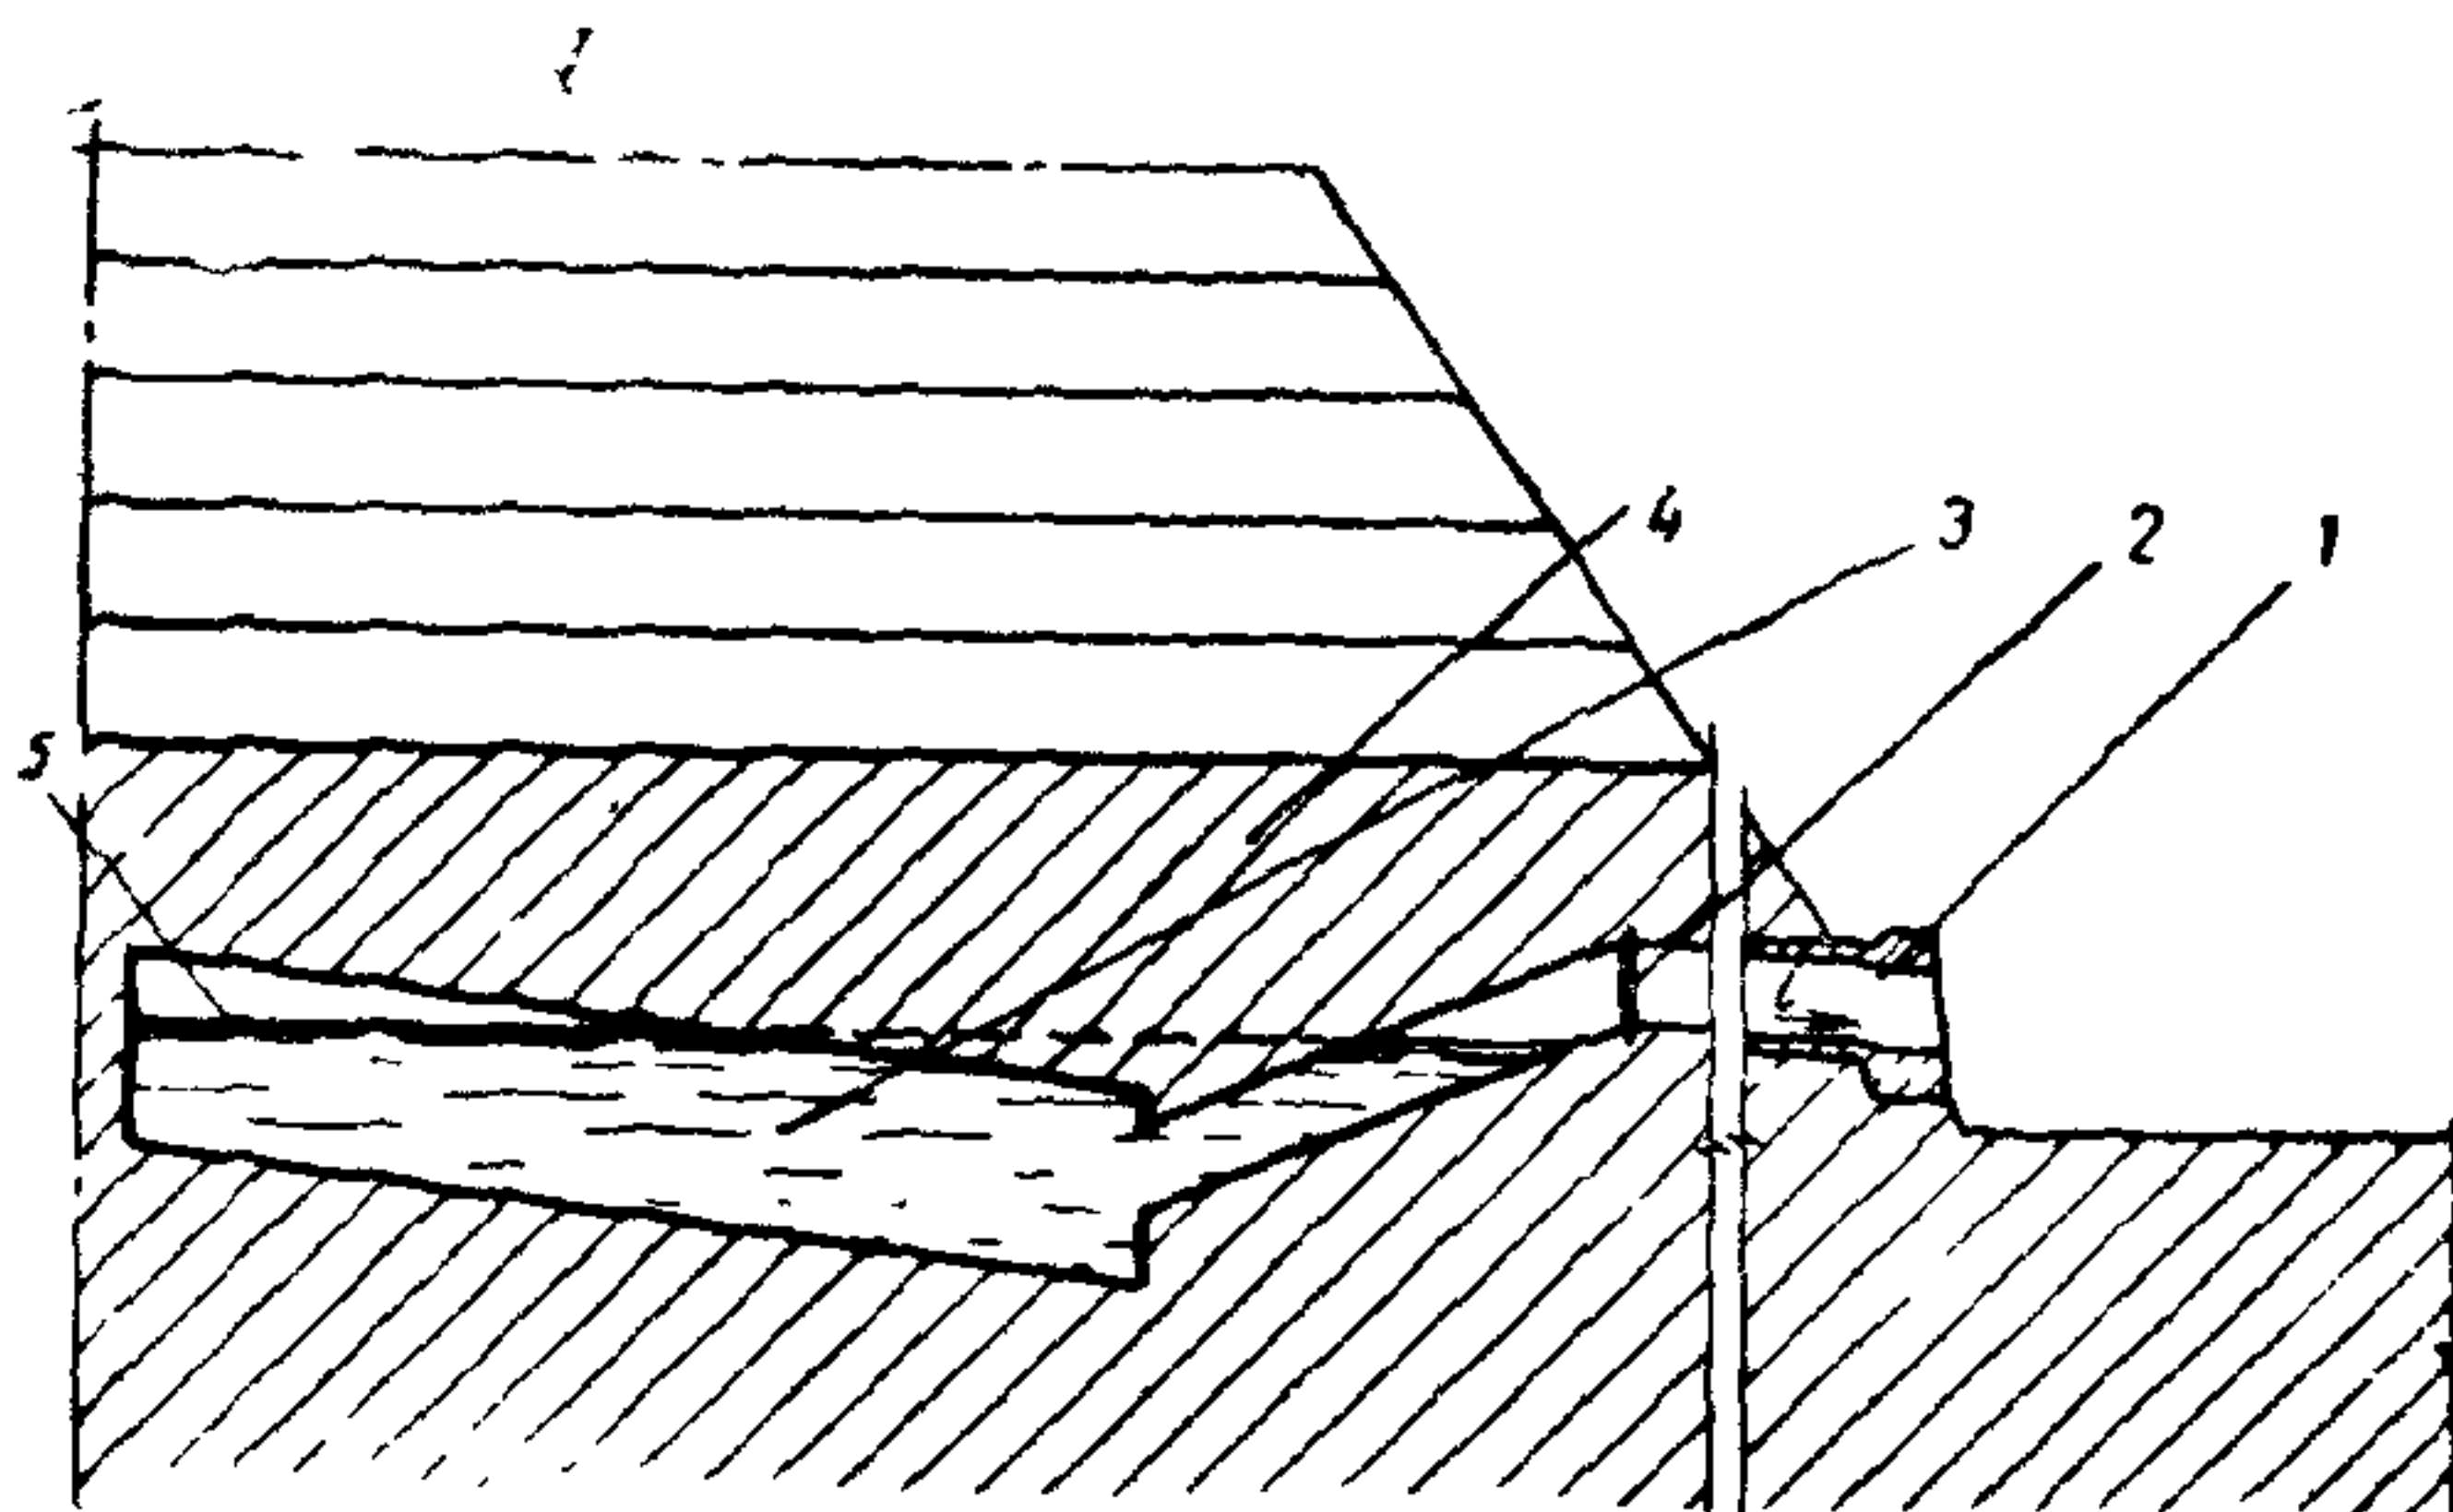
Схема хранилища с горизонтальной вскрывающей выработкой
